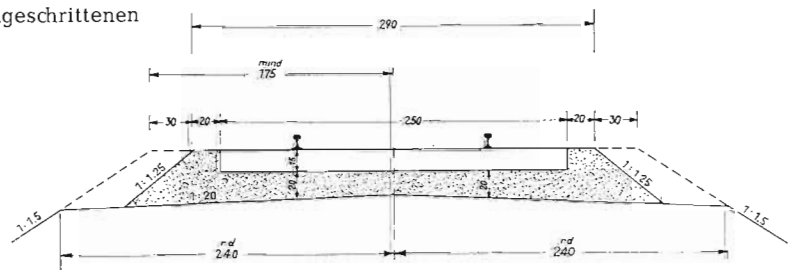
Schnitt durch den Bahnkörper bei Anschlußbahnen (Privatgleisanschlüssen)
